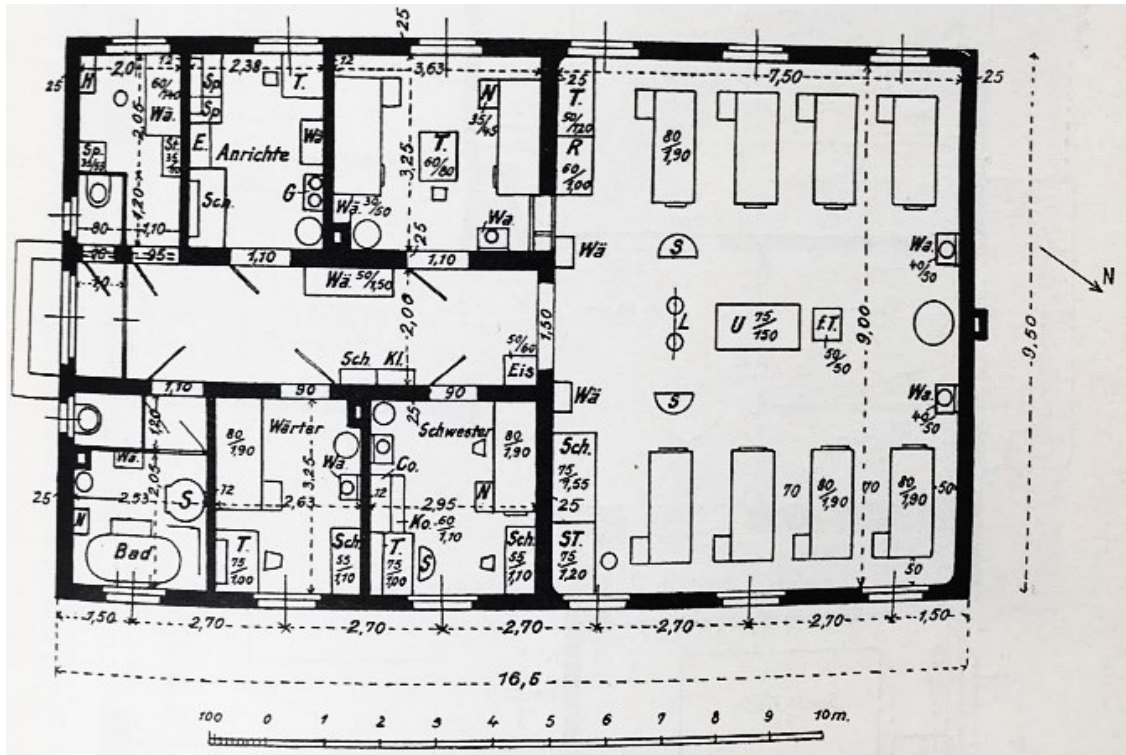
Grundriss der Krebsbaracken der Charité (1910)
